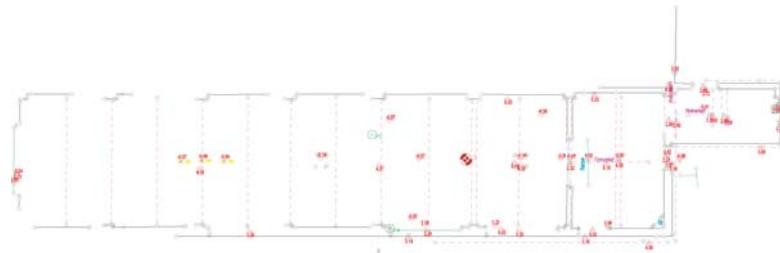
Grundriss Gebäude Nr. 70, Ebene 1 in AutoCAD mit dem Erfassungssystem TachyCAD
